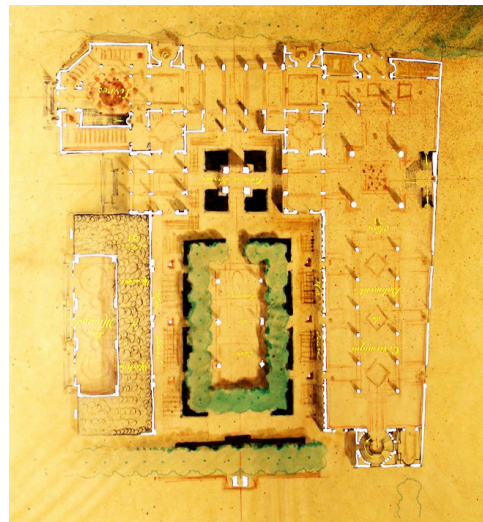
Segunda versión de la Planta del Pavillon de la Céramique, Verrerie et Manufacture de Sèvres.
